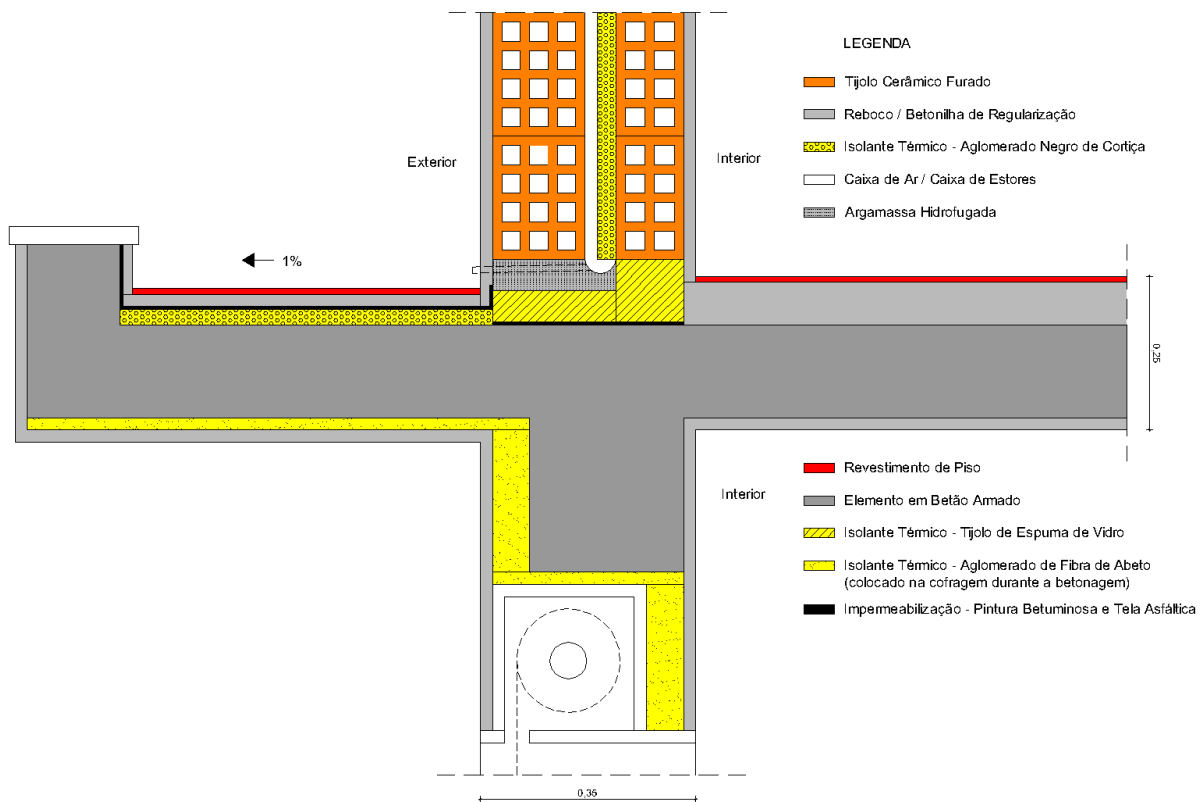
Ligação da fachada com varanda / caixa de estore, adaptado de [10]
